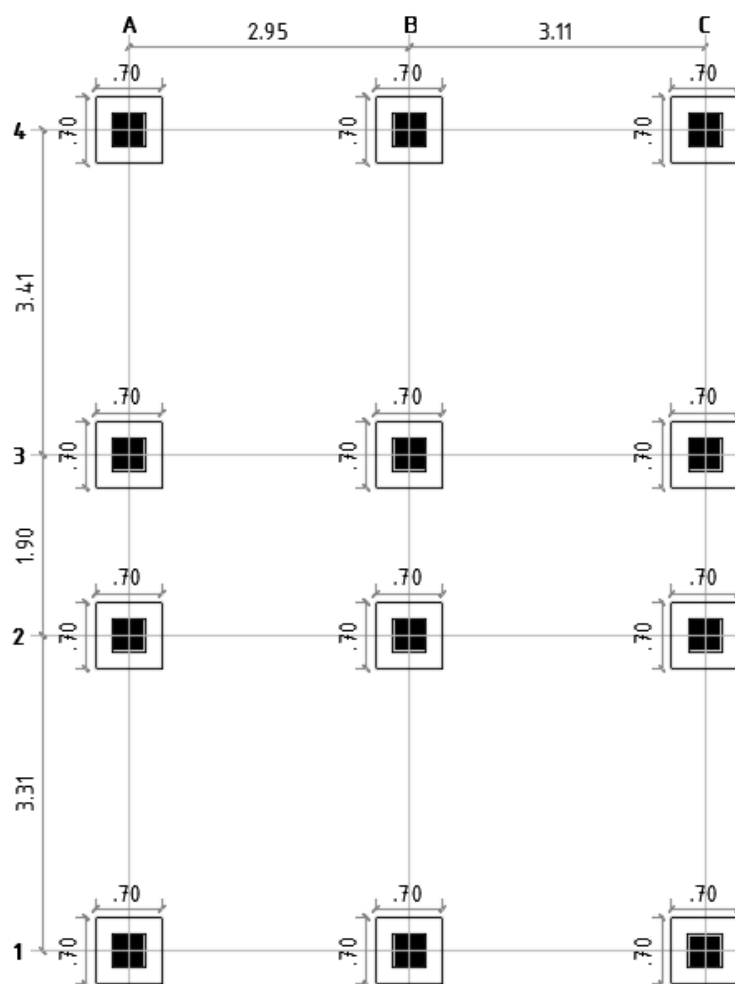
Planta con puntos de zapata para referencia de fuerzas y momentos
